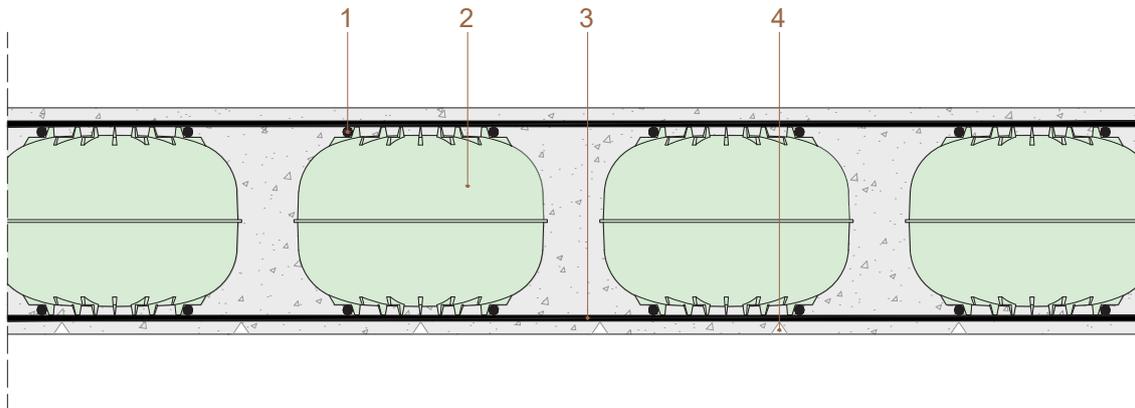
Sección tipo de forjado de losa aligerada in situ (CHE)
